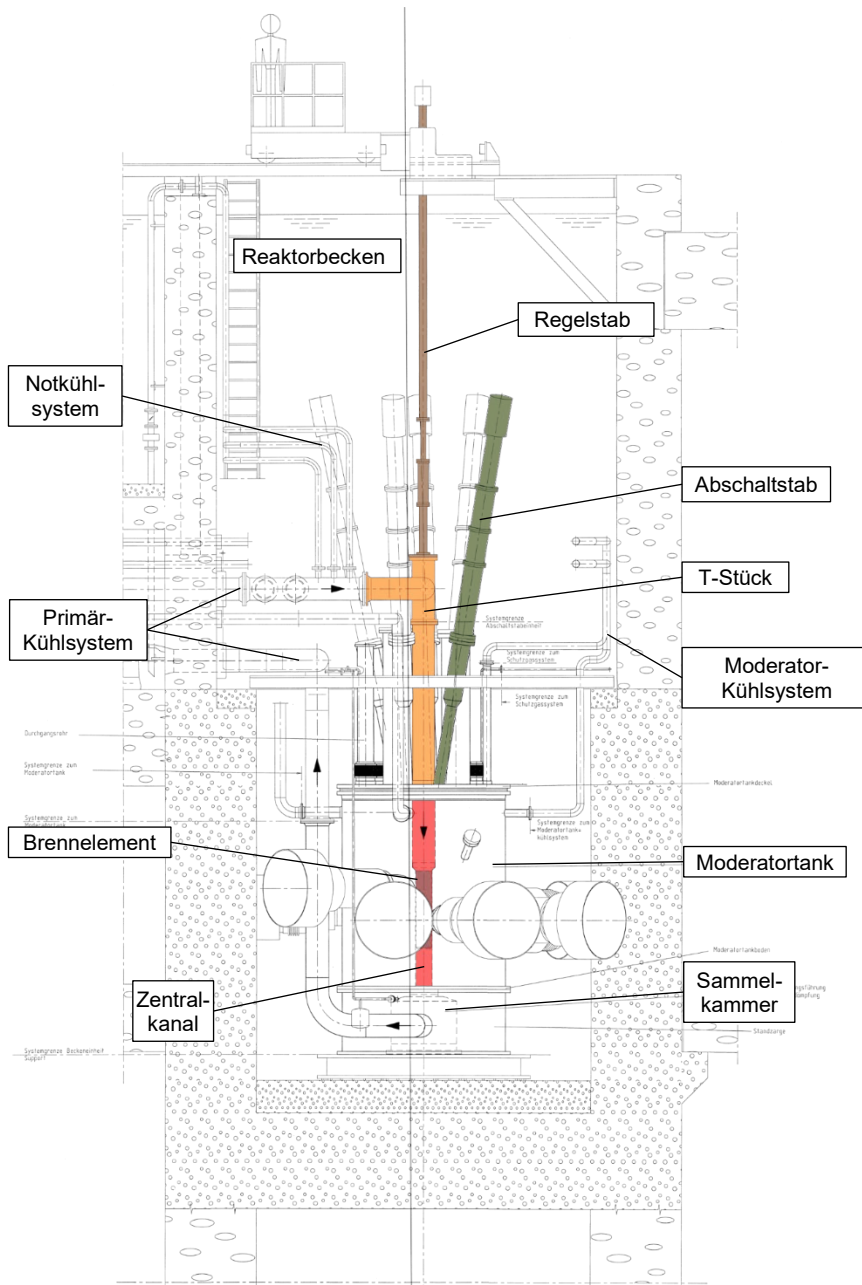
FRM II Reaktorbecken mit Einbauten (Original-Zeichnung bearbeitet)
